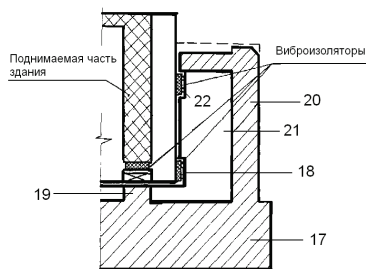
Схема виброизоляции цокольного этажа в основании здания.
